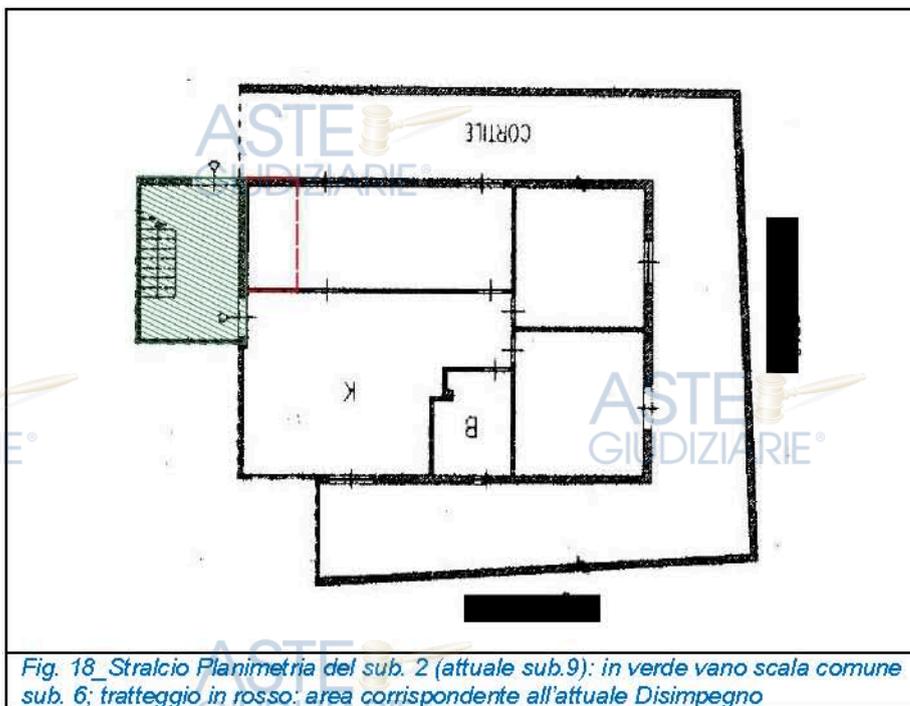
\_ Stralcio Planimetria del sub. 2 (attuale sub.9): in verde vano scala comune sub. 6; tratteggio in rosso: area corrispondente all'attuale Disimpegno
